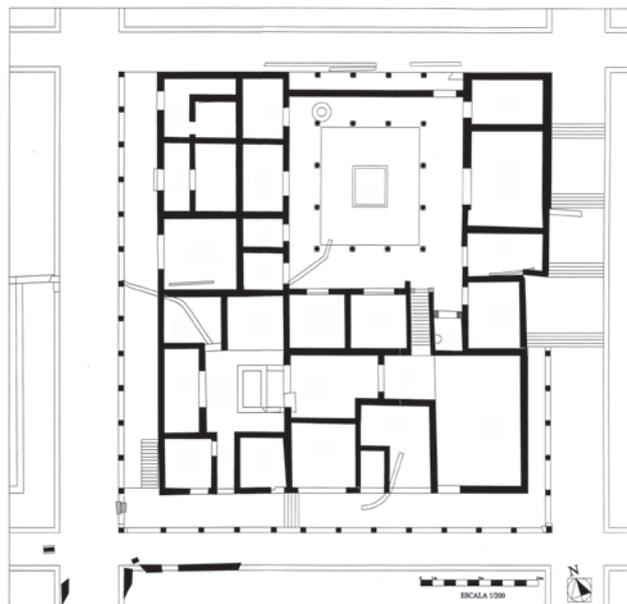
Planta da casa das Carvalheiras (Fase I).
